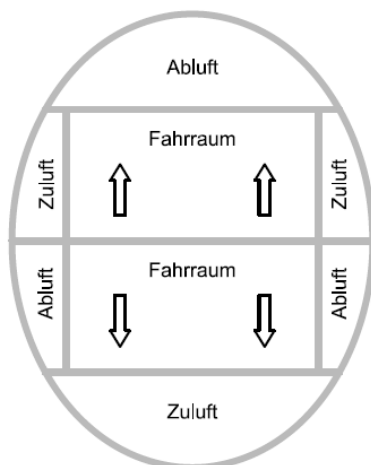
einröhriger Tunnel mit getrennten Richtungsverkehrsbahnen
